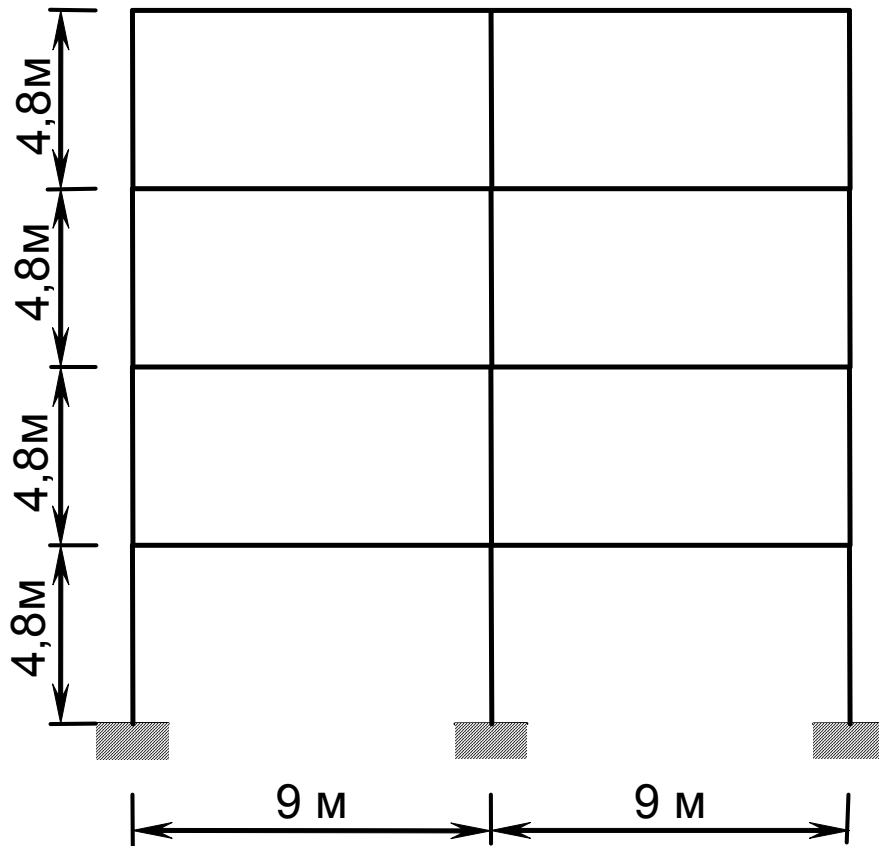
Расчётная схема рамы при жёстком сопряжении ригелей с колоннами
